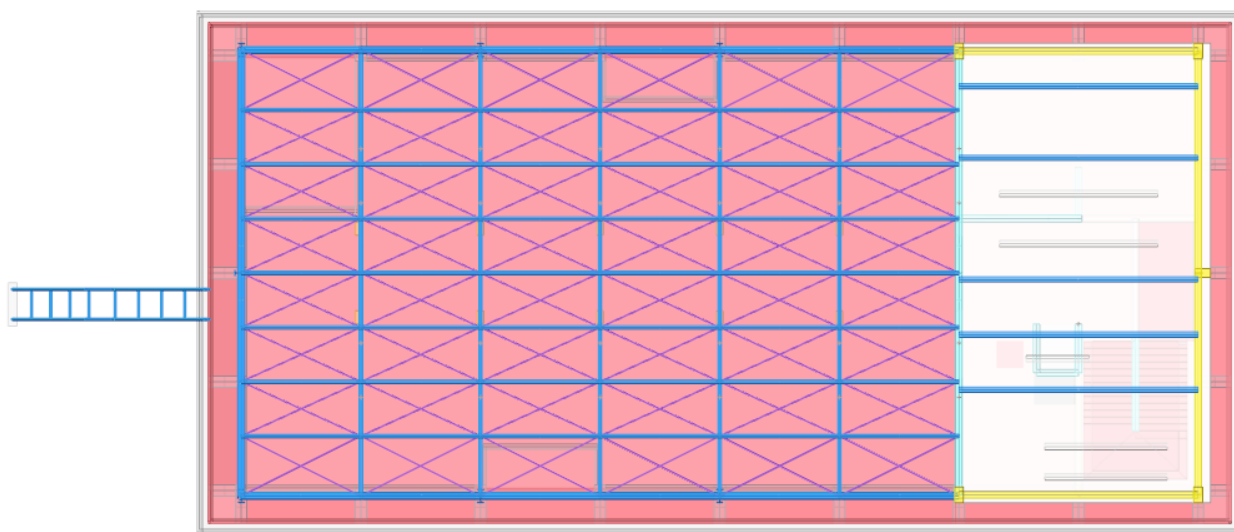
Vista 3D del Modello Strutturale FEM – Corpo A – Vista in Pianta – Stato di Progetto
